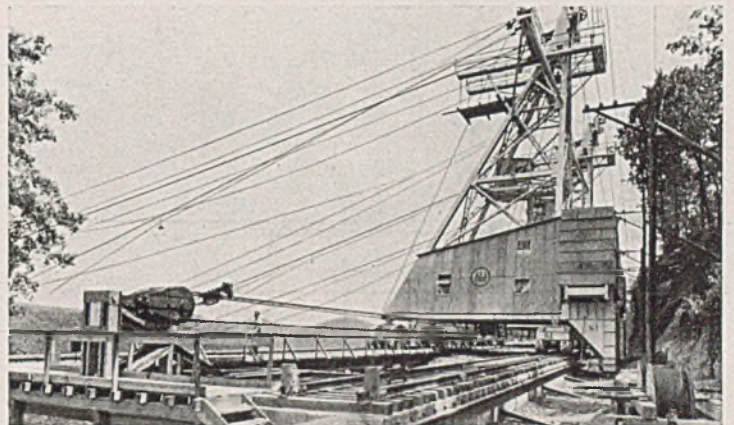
Maschinenturm des Kabelkranes Nr. 1 mit der Seil-Endbefestigung für die Fahrbewegung des Turmes.
